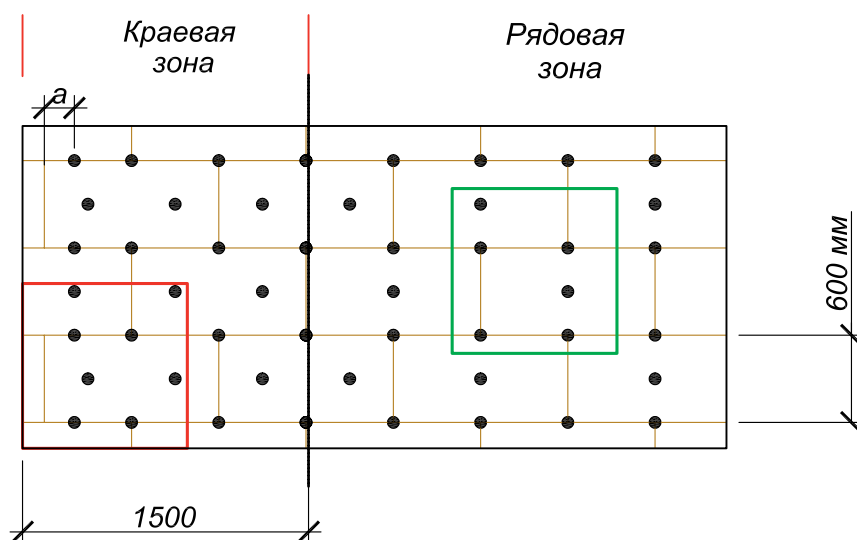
Система фасадная теплоизоляционная композиционная с теплоизоляцией из экструзионного пенополистирола XPS
